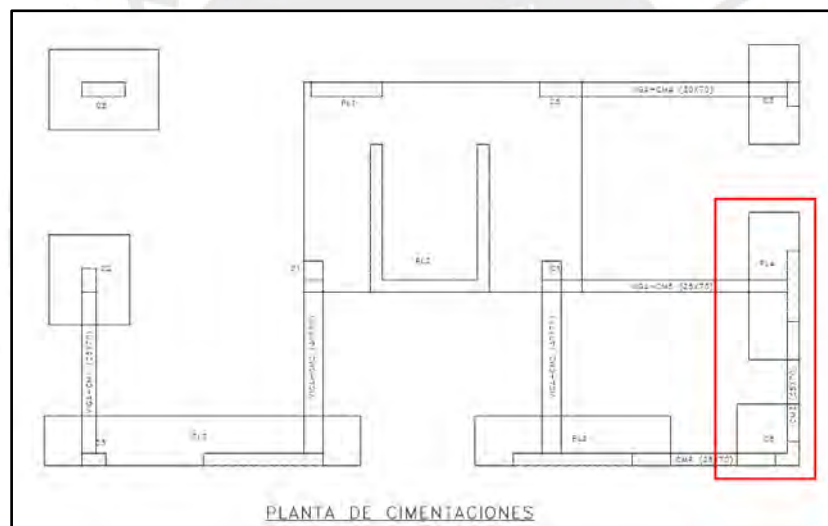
Planta de cimentaciones y resaltadas las cimentaciones cuyo diseño será detallado
